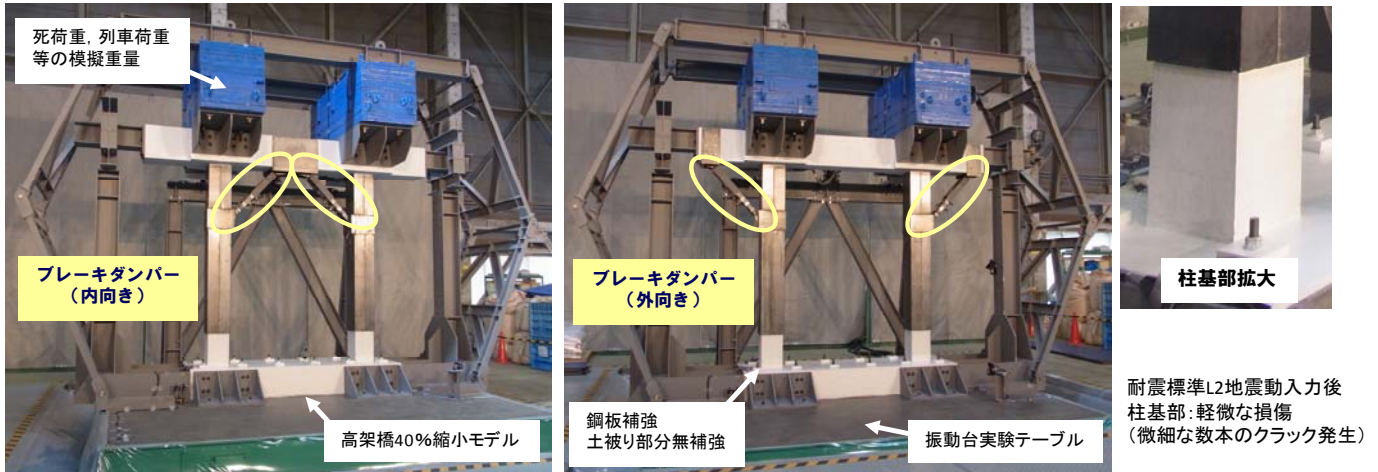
ブレーキダンパー (内向き・外向き) 振動台実験
